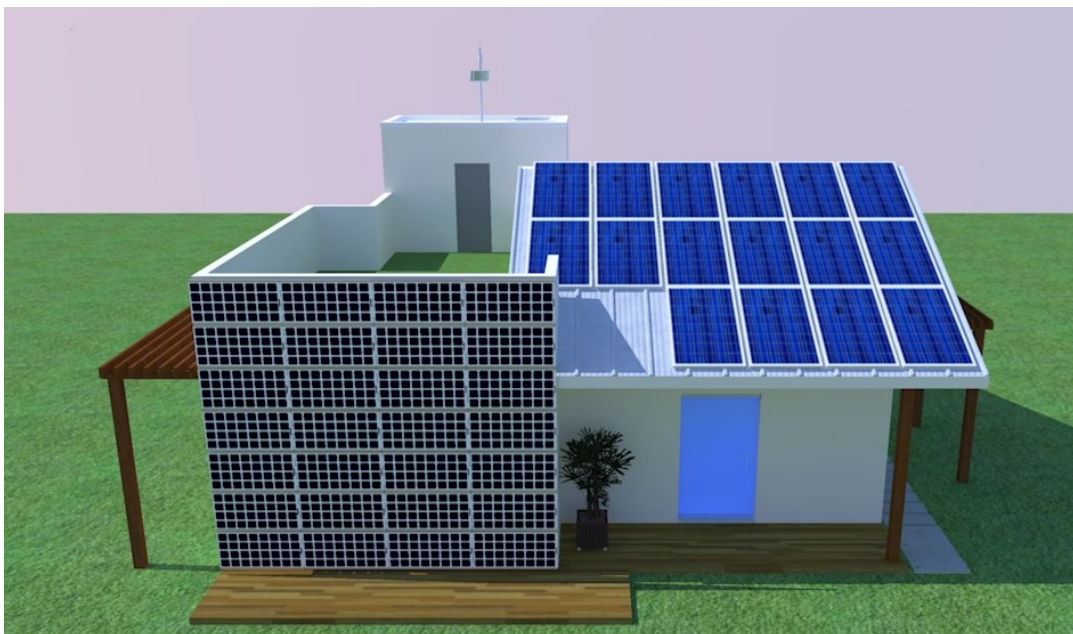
Sistema fotovoltaico da planta piloto. (Fonte: do autor).
